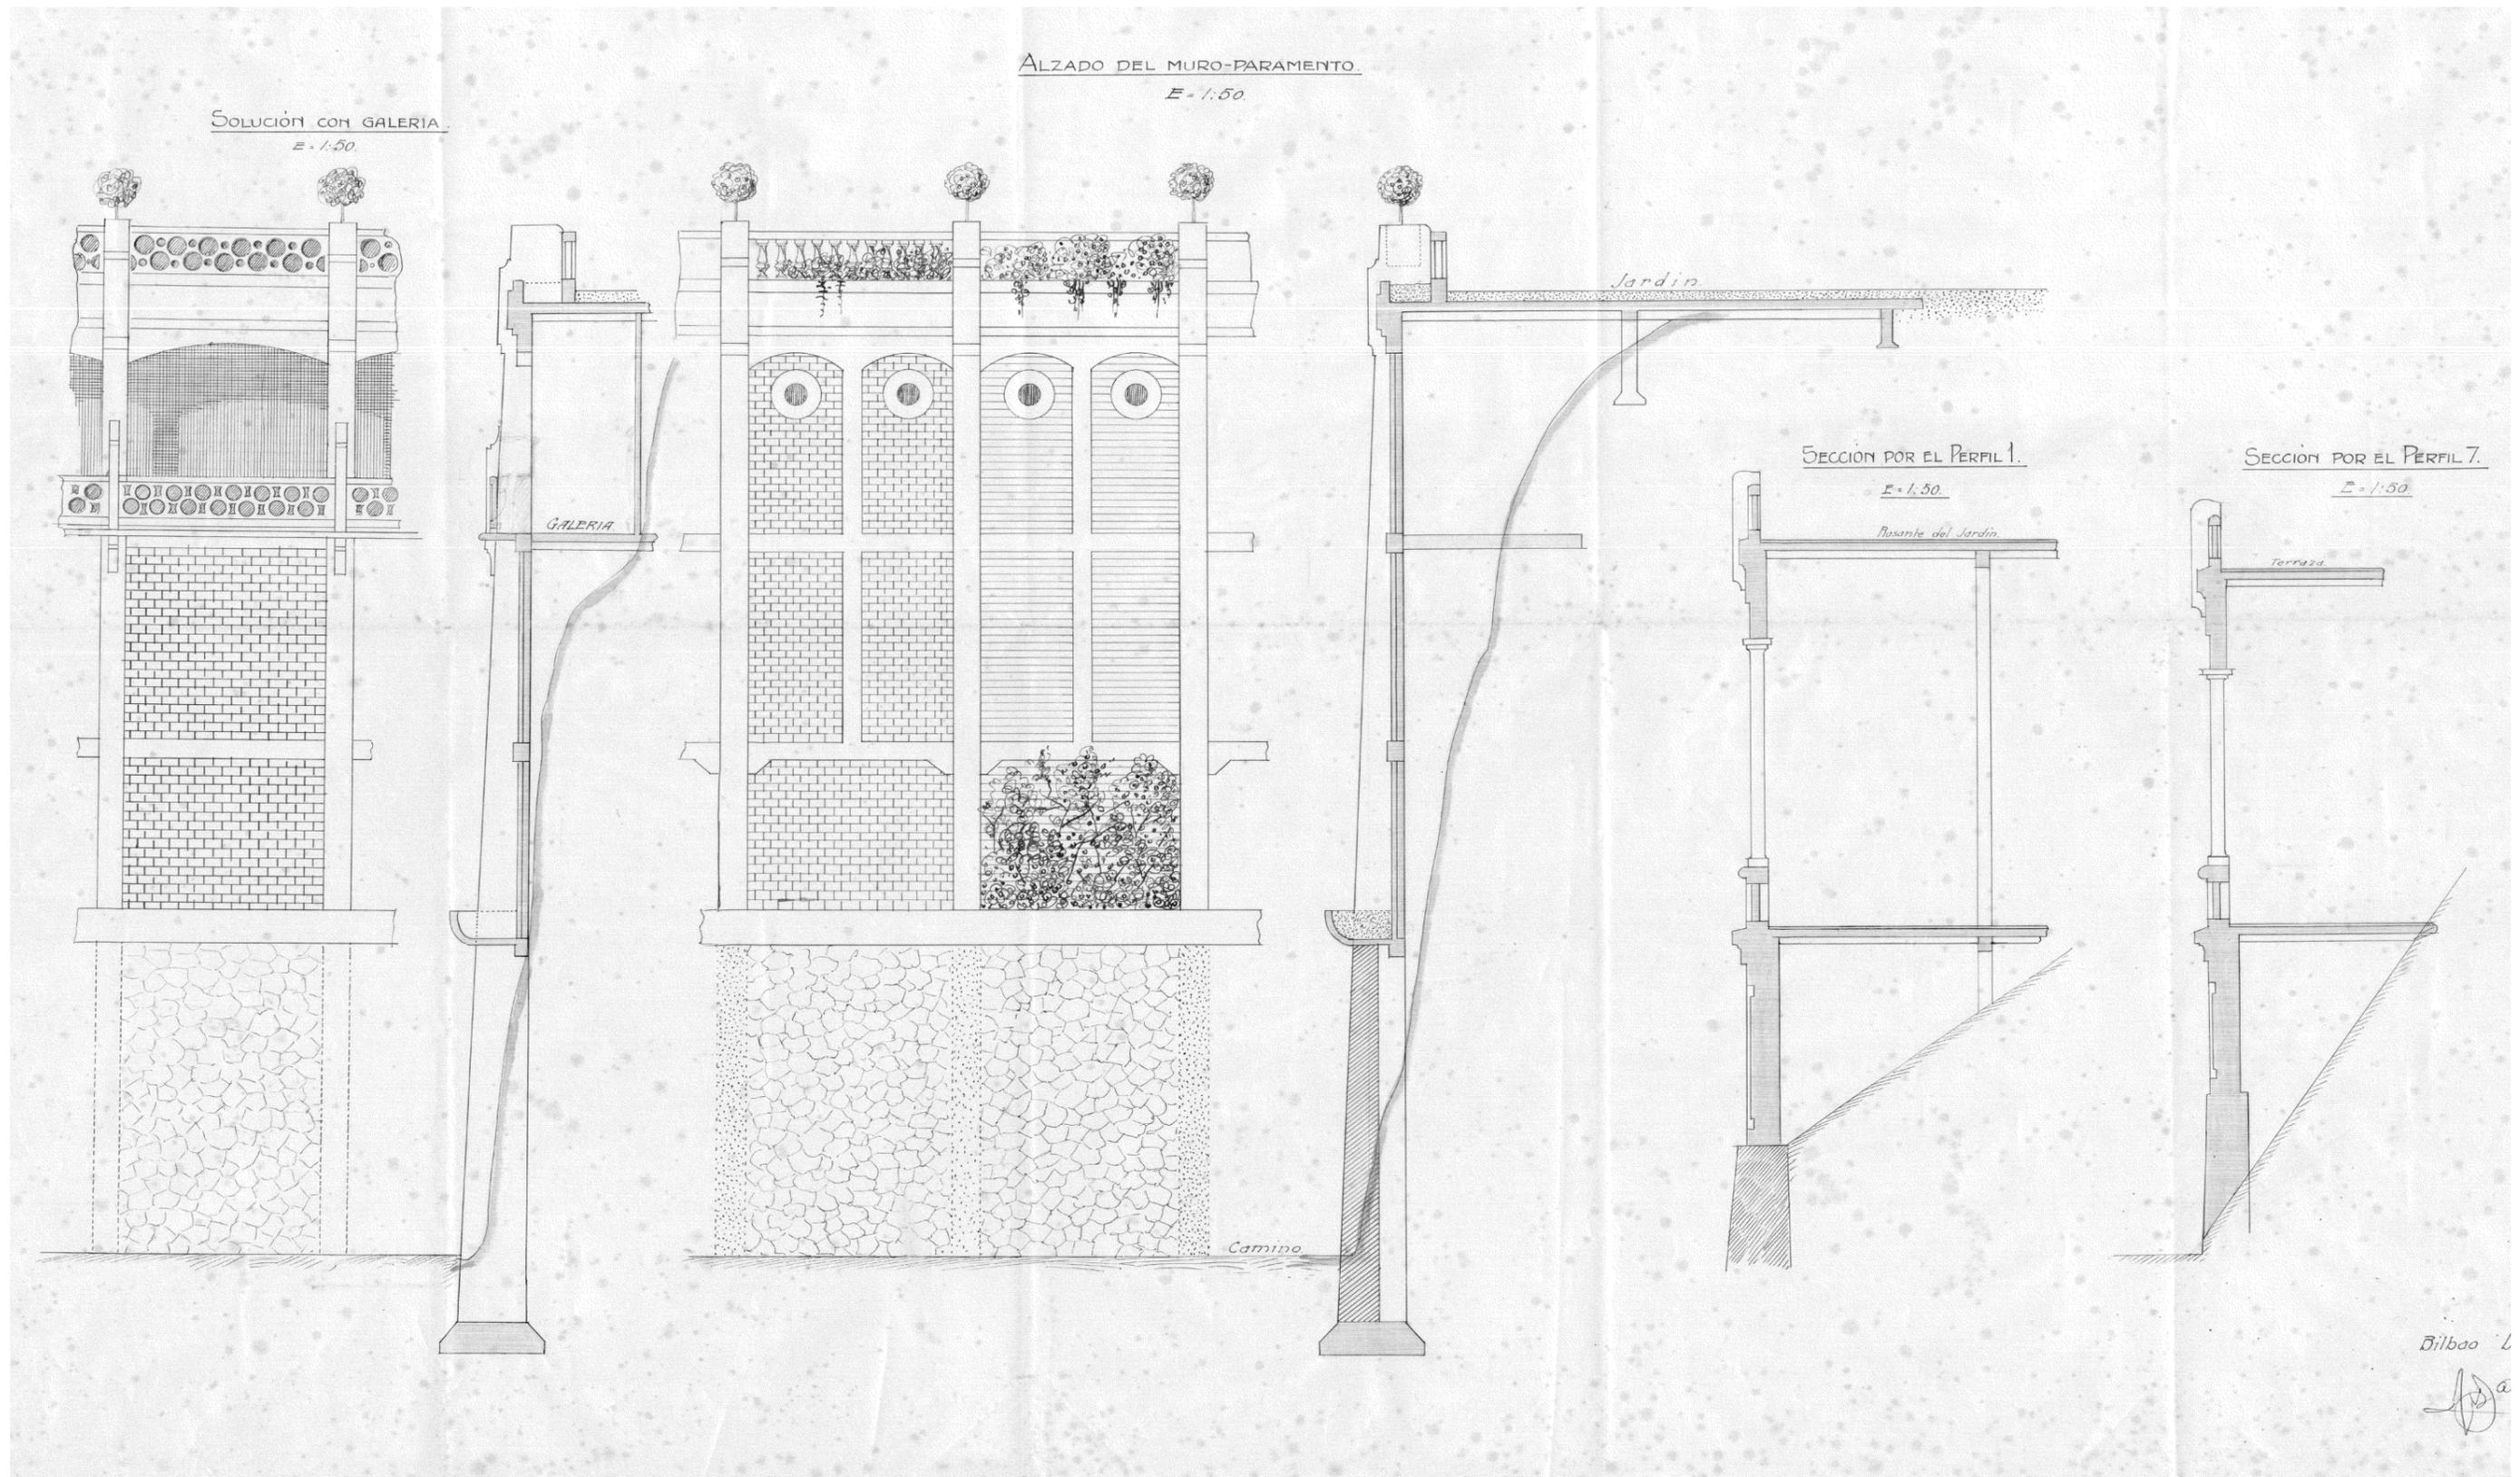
Detalles de alzado y sección del primer proyecto para las galerías por Ricardo Bastida, Archivo Municipal de Bilbao, Fondo Ricardo Bastida.
